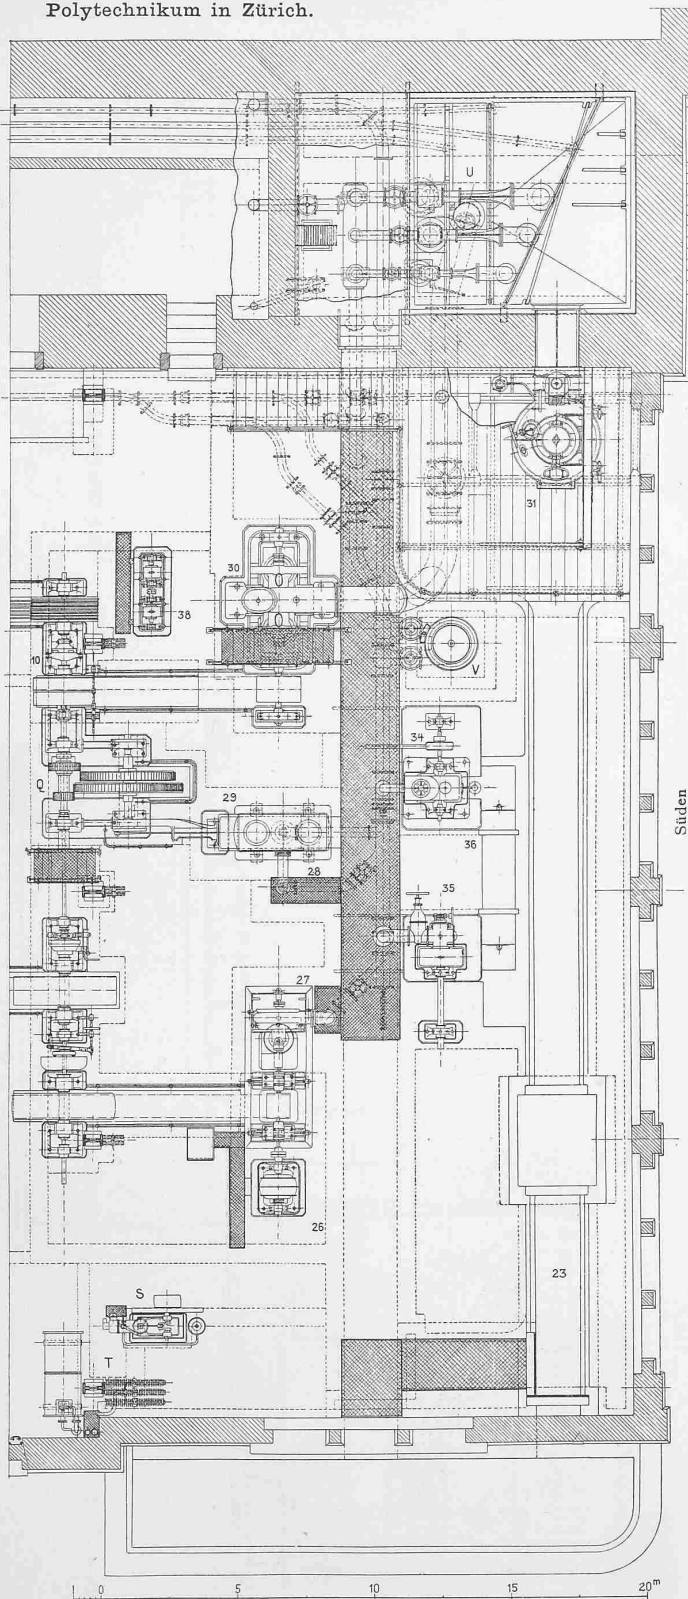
Grundriss der Maschinenhalle, südlicher Teil. 1:250.
